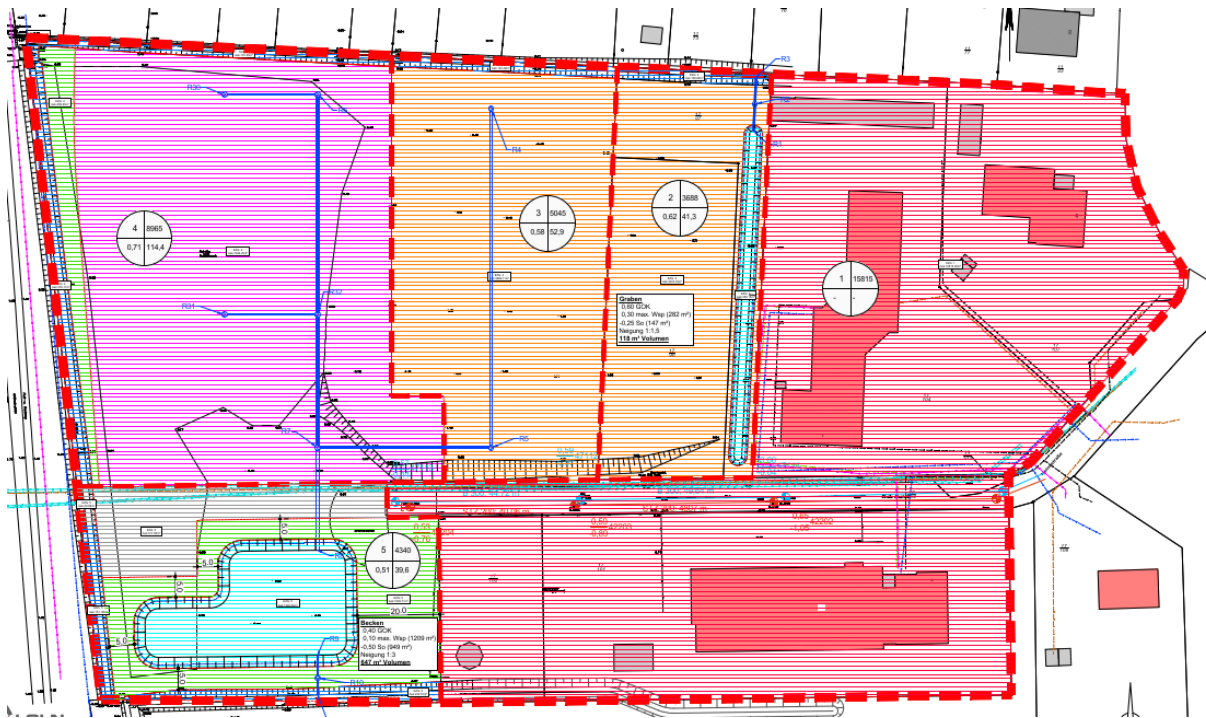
Lageplan aus dem Oberflächenentwässerungskonzept
